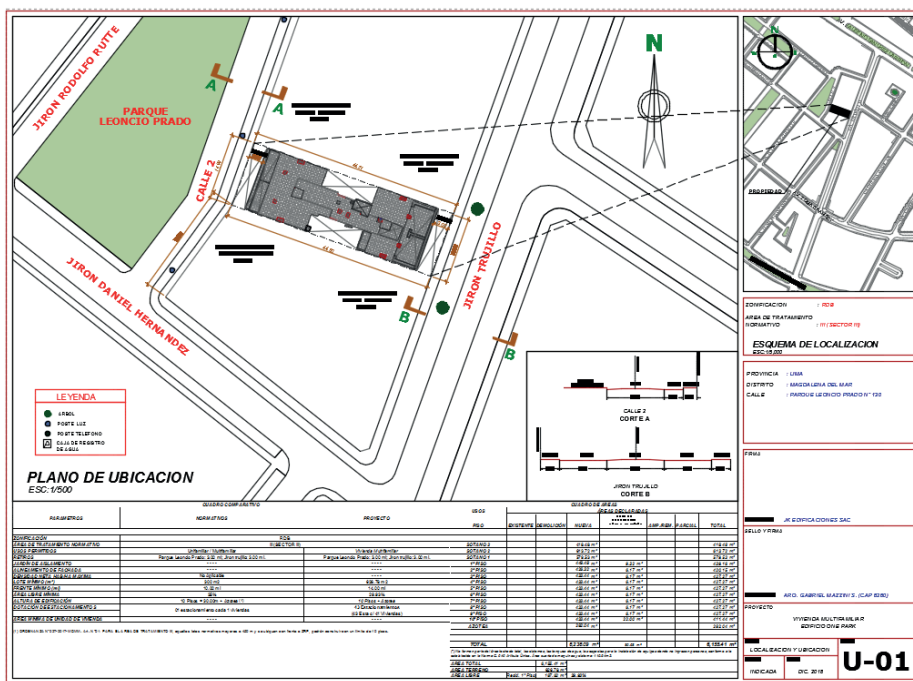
Planos de ubicación y localización. Proporcionada por la empresa Edificaciones JK SAC.
